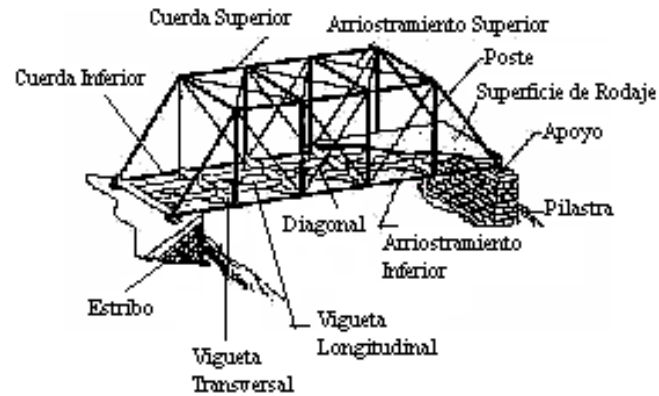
Elementos de un puente de armadura de tablero inferior.
